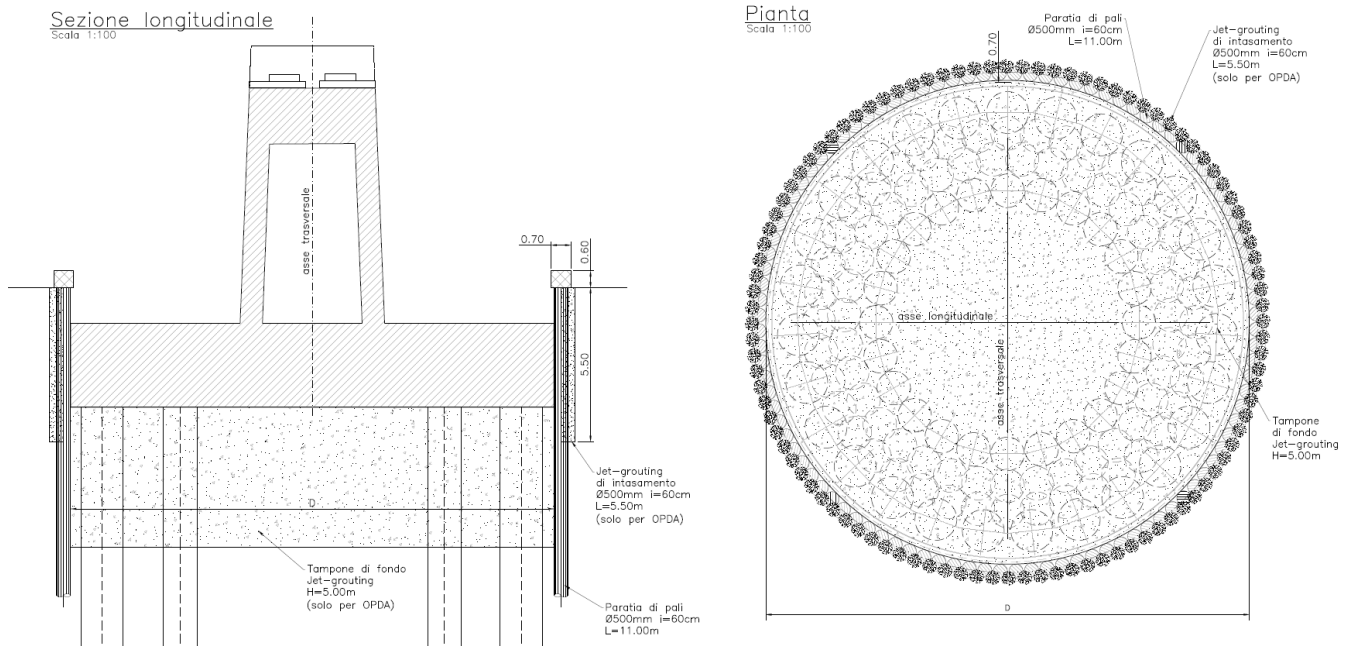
Sezione tipo – pali diametro 500mm (con tappo di fondo in jet grouting)
